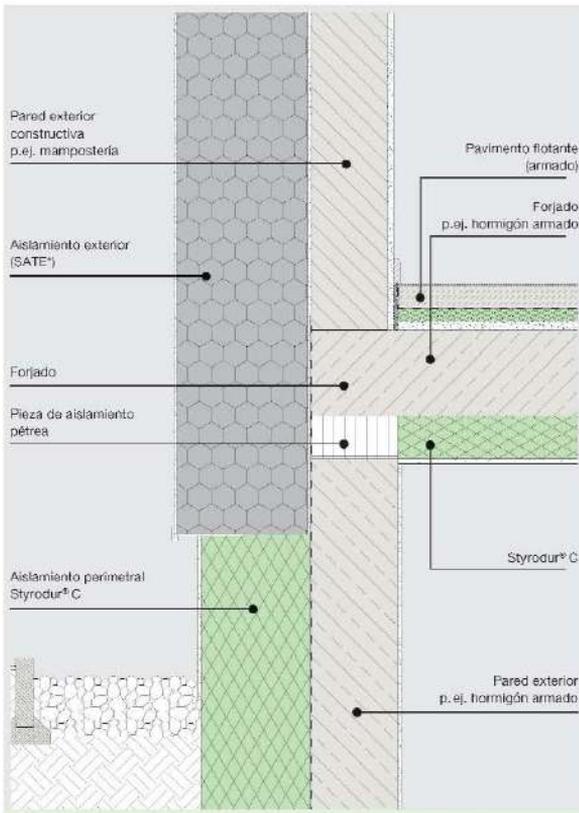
Aislamiento sobre techo de sótano con calefacción.
